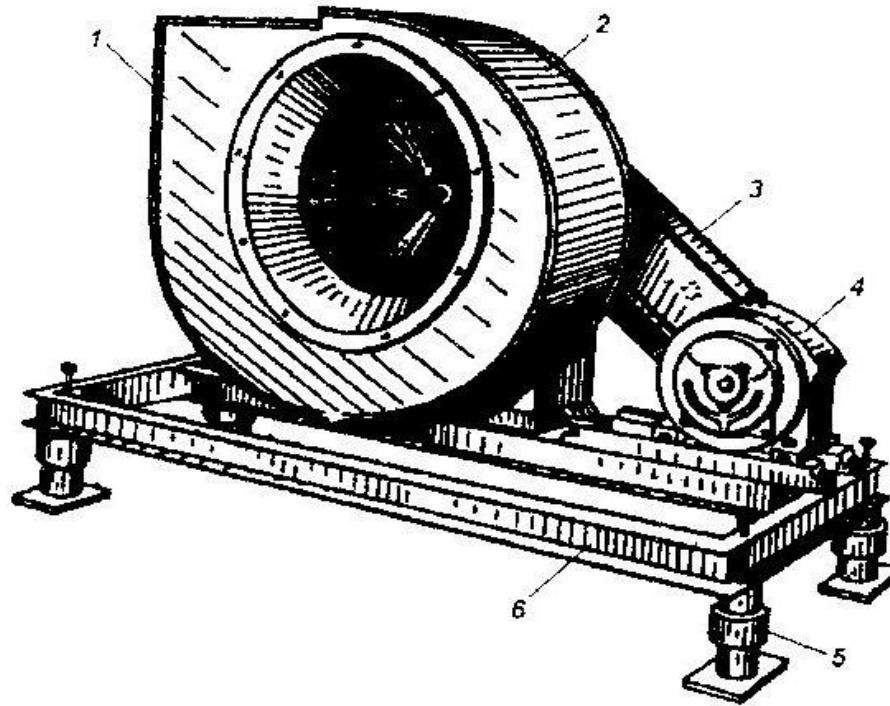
Общий вид вентиляторной установки на виброизолирующем основании:
